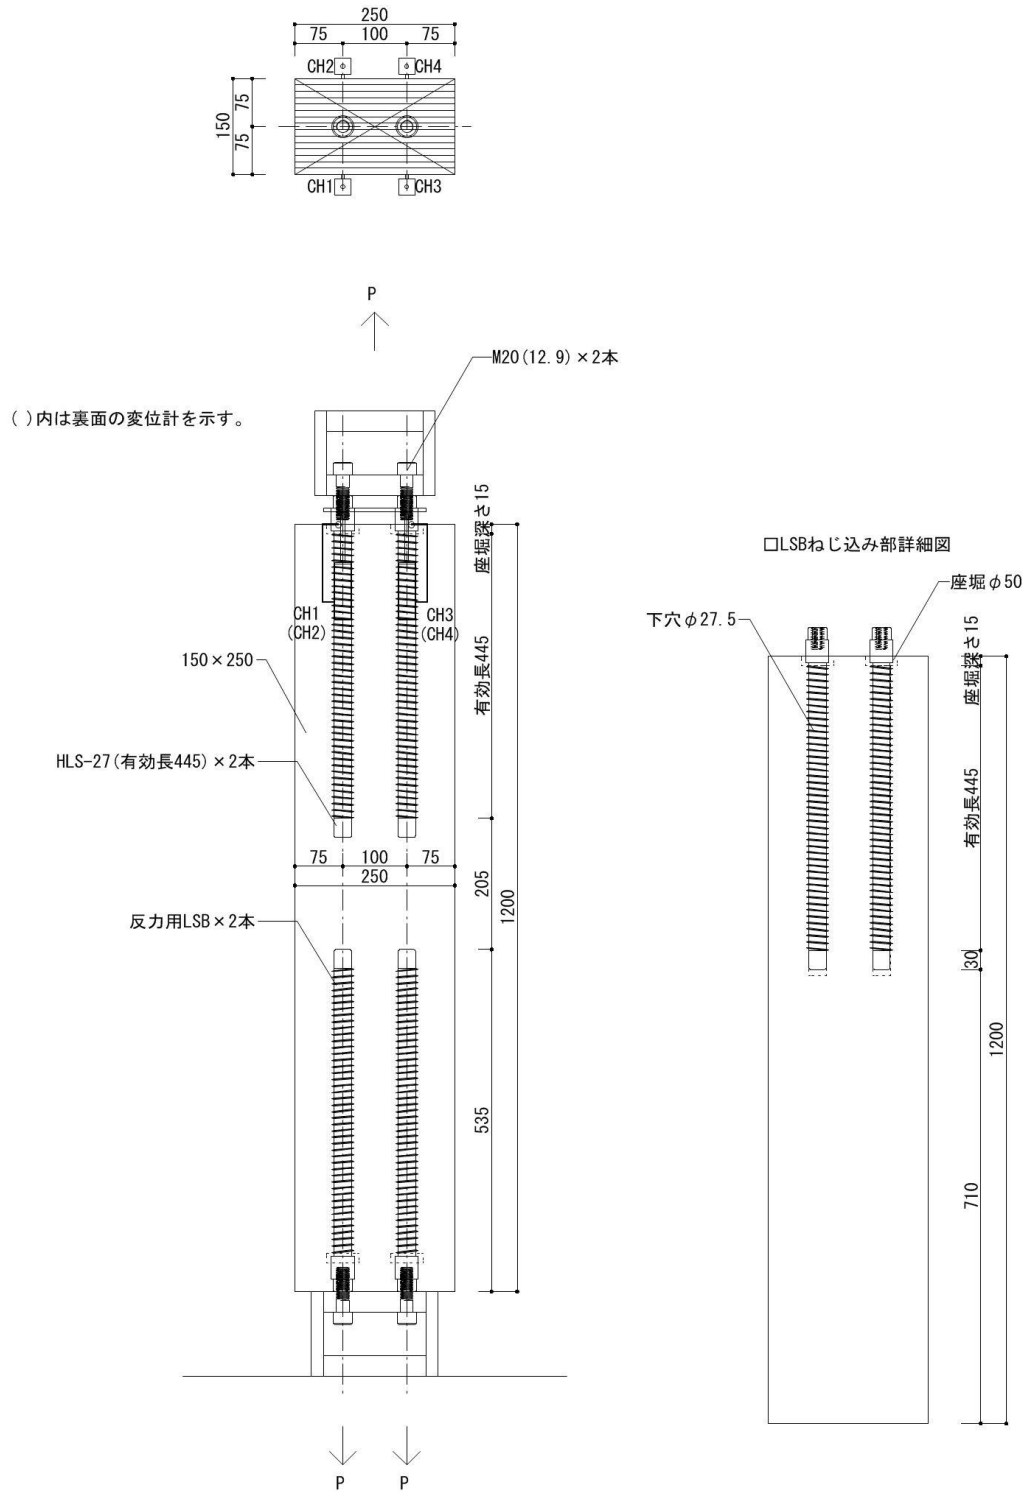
試験体の形状及び寸法 (C-2)
